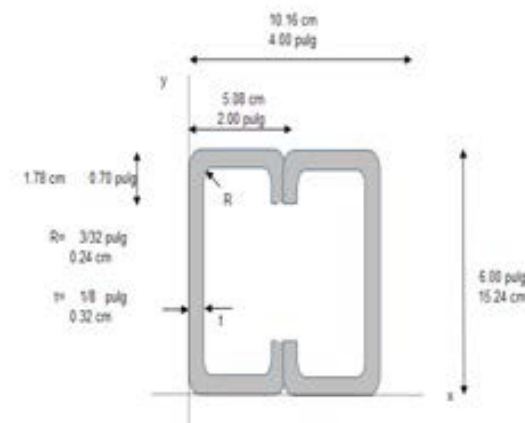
Vista transversal de clavadador para el sistema de techo.
